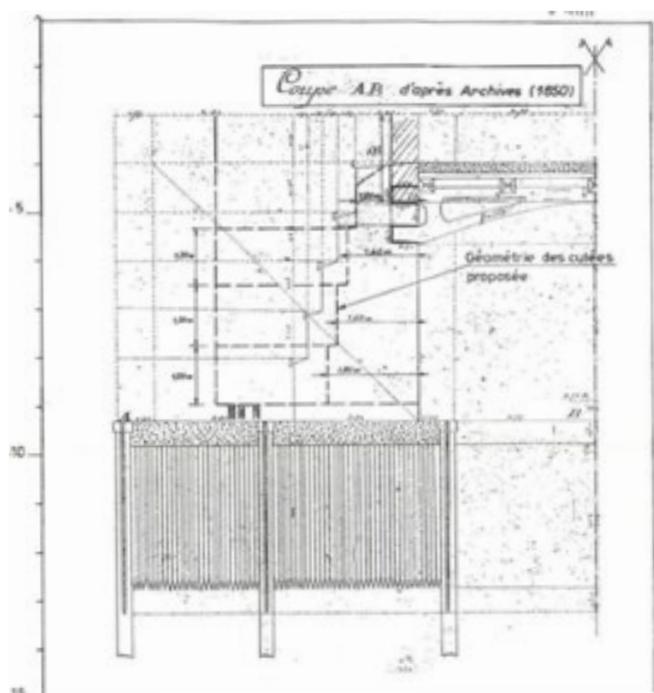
Plan d'archives du pont du Bouil sur le Langon
